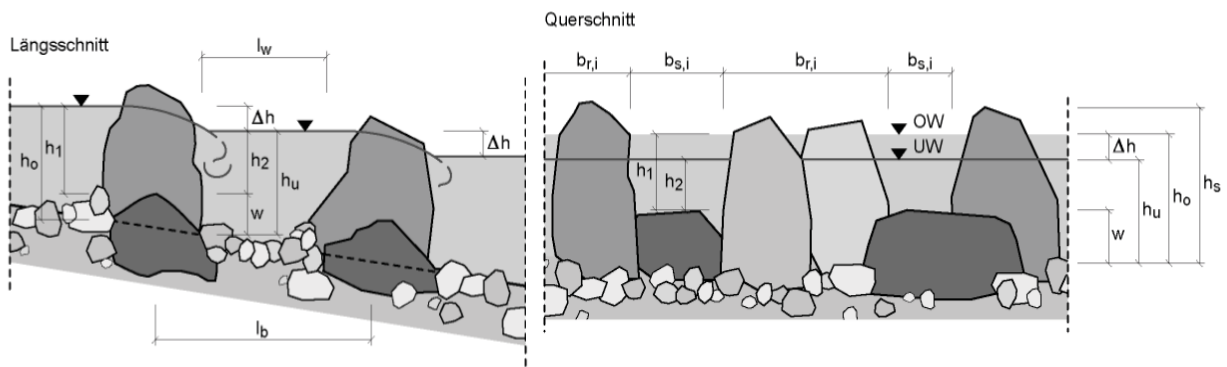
Definitionsskizze für die Berechnung von Steinschwellen aus DWA-M 509
